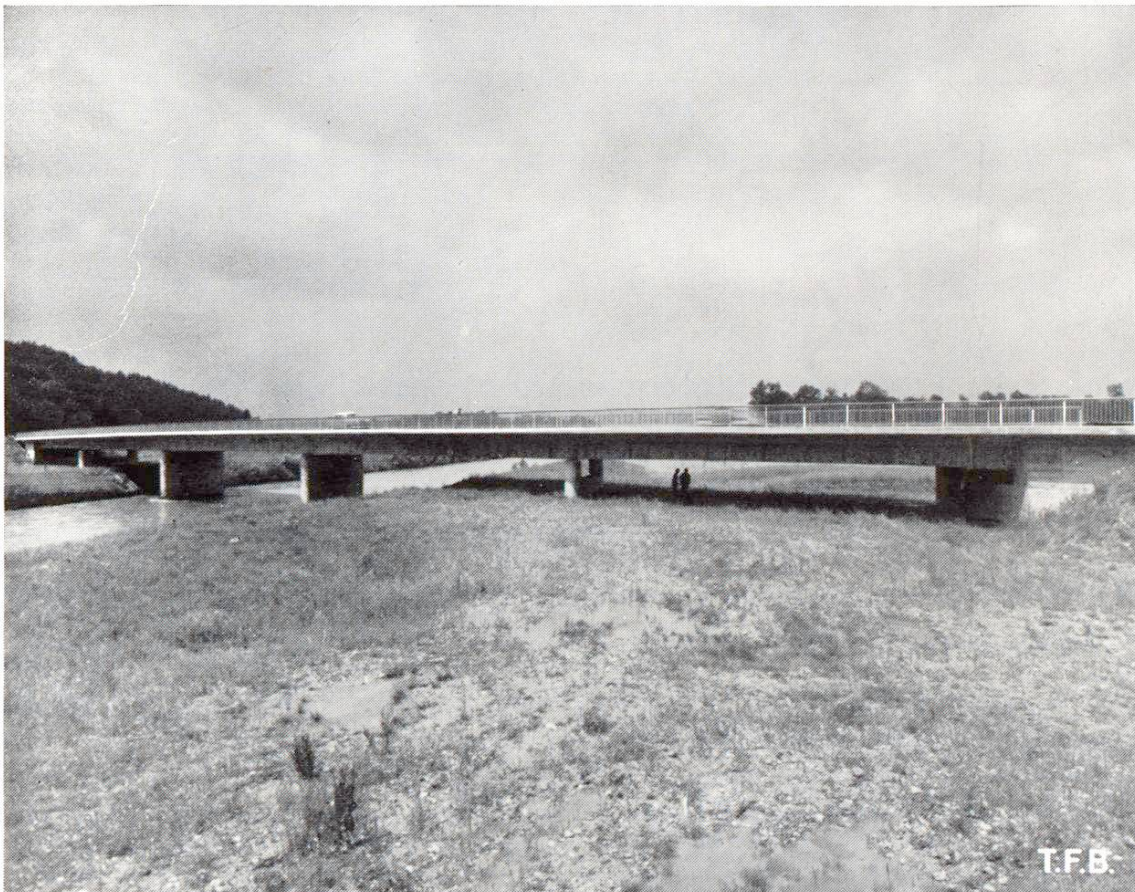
Pont sur la Thur, près d'Eschikofen, construit en 1953/54
